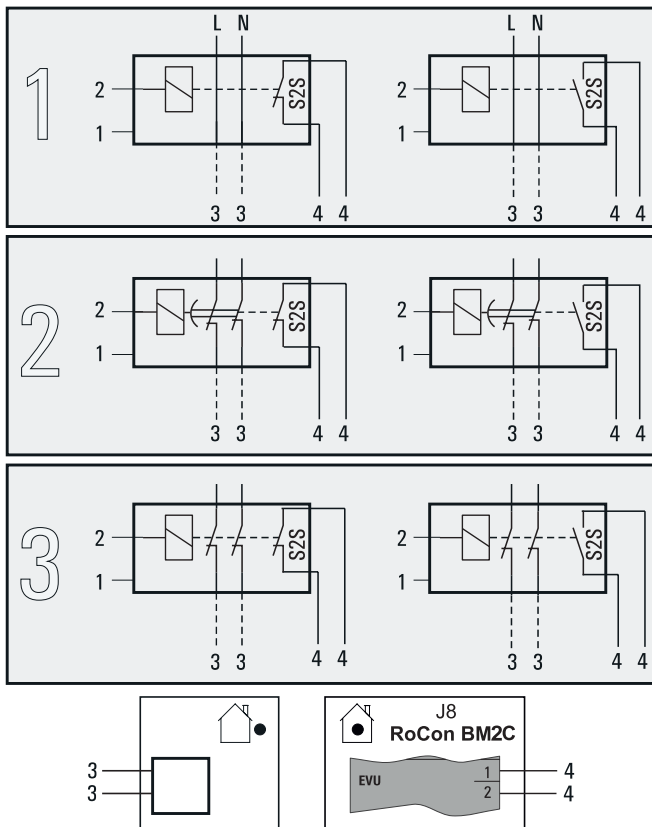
Collegamento del contatto di commutazione H/NT
